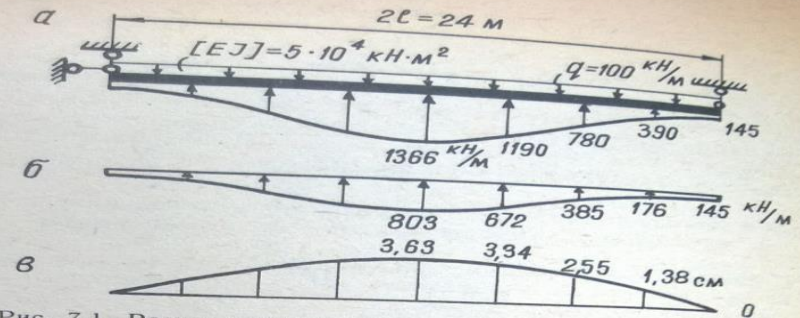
Расчет стены здания на неравномерный подъем основания: а) расчетная схема; б) эпюра давления пучинистого грунта после достижения равновесия системы балка-основание; в) эпюра перемещений балки
